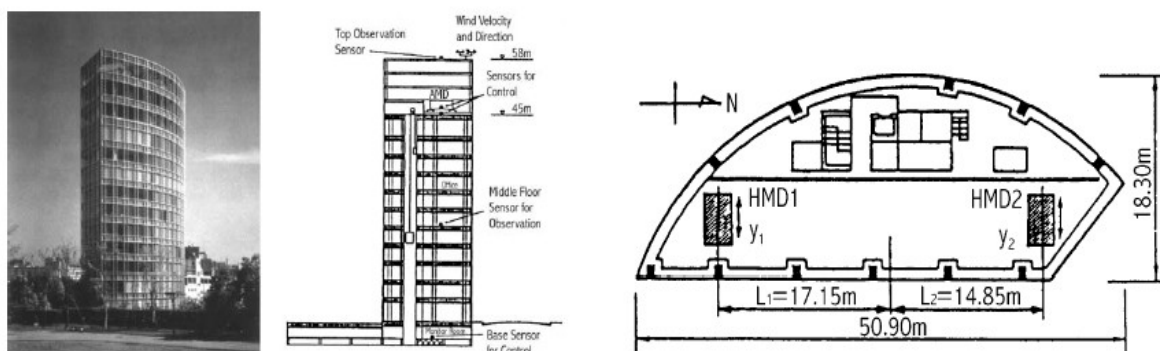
Foto, sezione del Sendagaya INTES Building e vista dall'alto della configurazione dell'HMD
